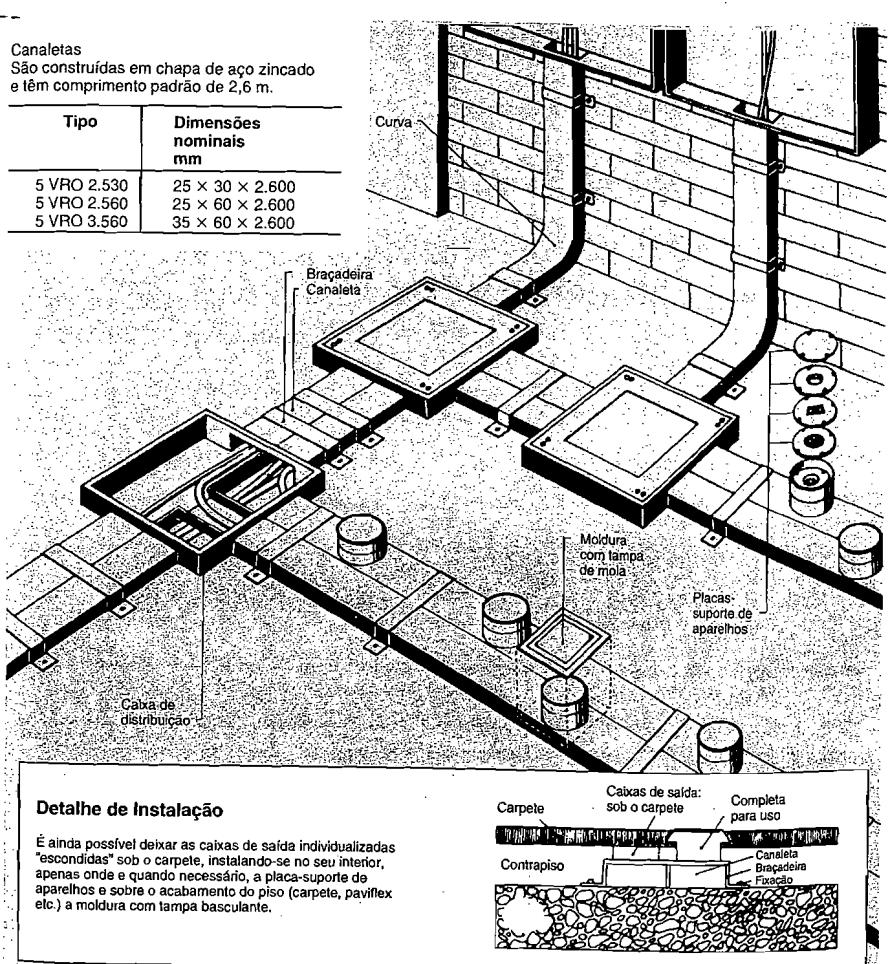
Sistema SIK da Siemens de canaletas de piso com caixas de saída simples para tomadas de piso
